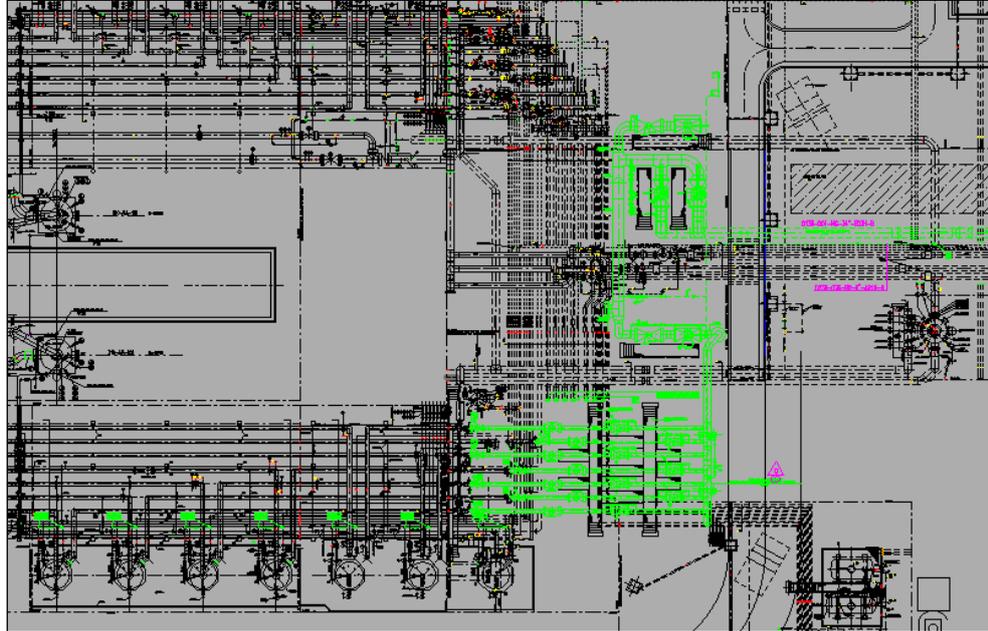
Planimetria Tie-ins di Centrale – Fase 1 (in verde nuove installazioni Fase 1)
